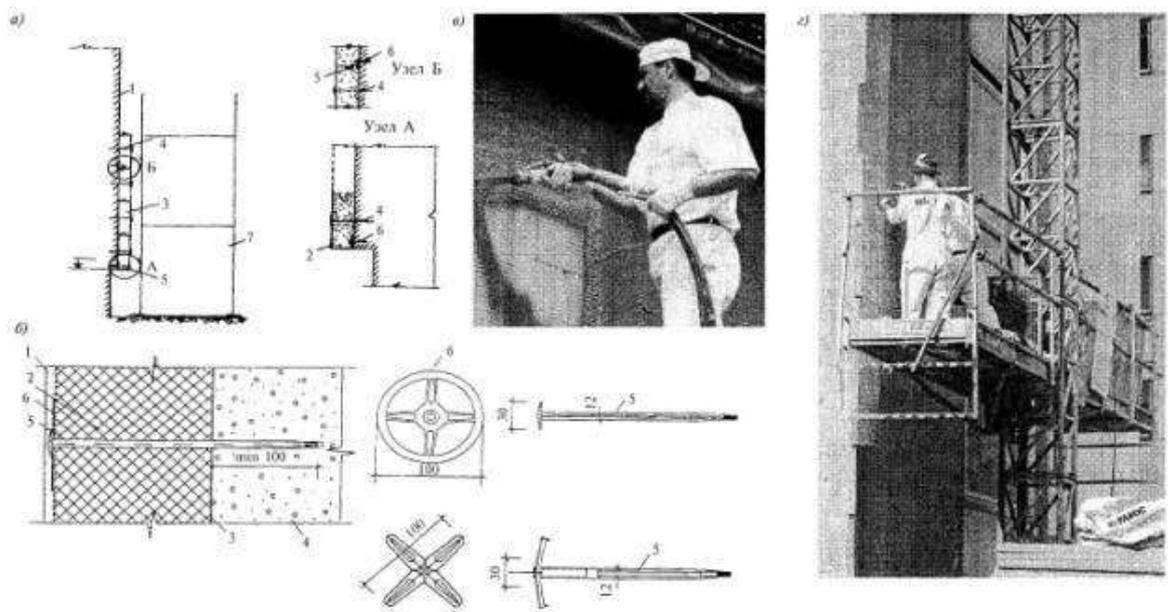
Технологічна схема утеплення фасадів плитним утеплювачем (а) із кріпленням розпірними анкерами й (б) захистом штукатурним покриттям 1 -, що утеплюється стінова конструкція; 2 - напрямна першого ряду блоків; 3 - пінополістирольний блок; 4 - полімерний анкер; 5 - напрямна порядовка; 6 - анкер-дюбель; 7 - помости; в, г - робочі моменти нанесення штукатурного покриття
